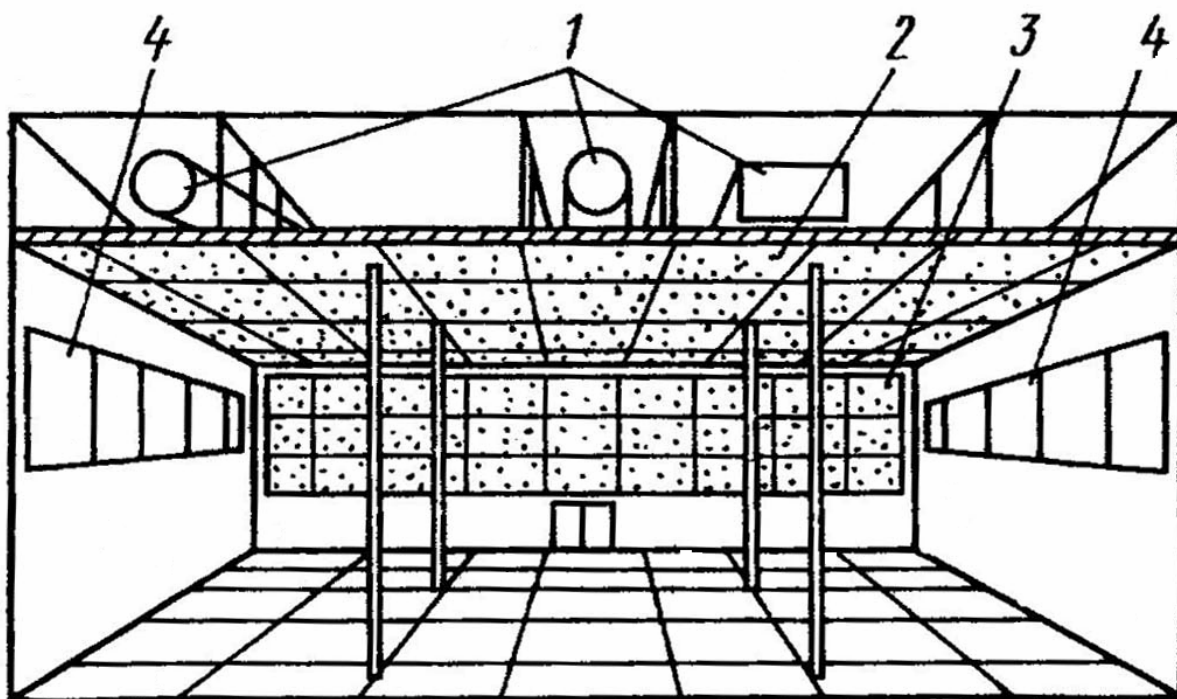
Схемы размещения звукопоглощающих конструкций на потолках
